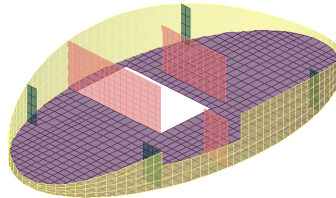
Esquema muros. Fuente: elaboración propia.
